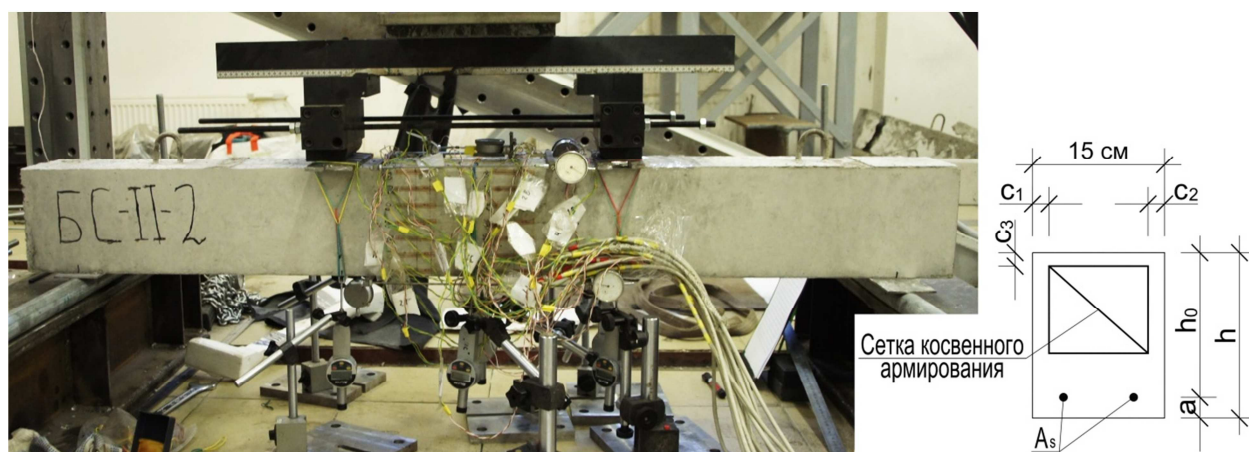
Подготовка балки к испытанию и параметры сечения
